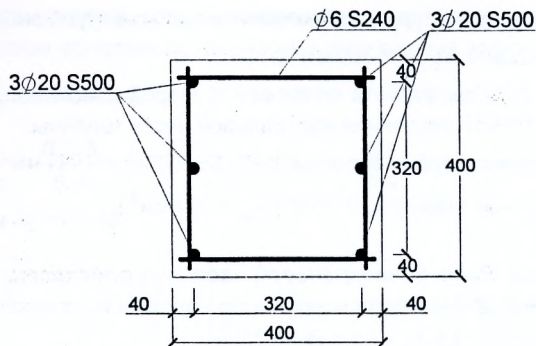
Армирование сечения надкрановой части колонн
